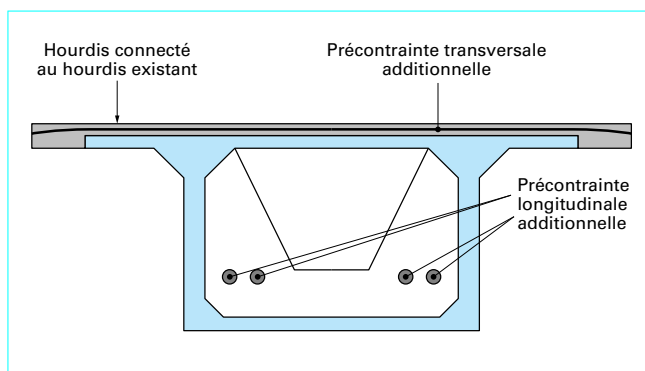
Élargissement de la dalle de couverture d'une poutre-caisson
